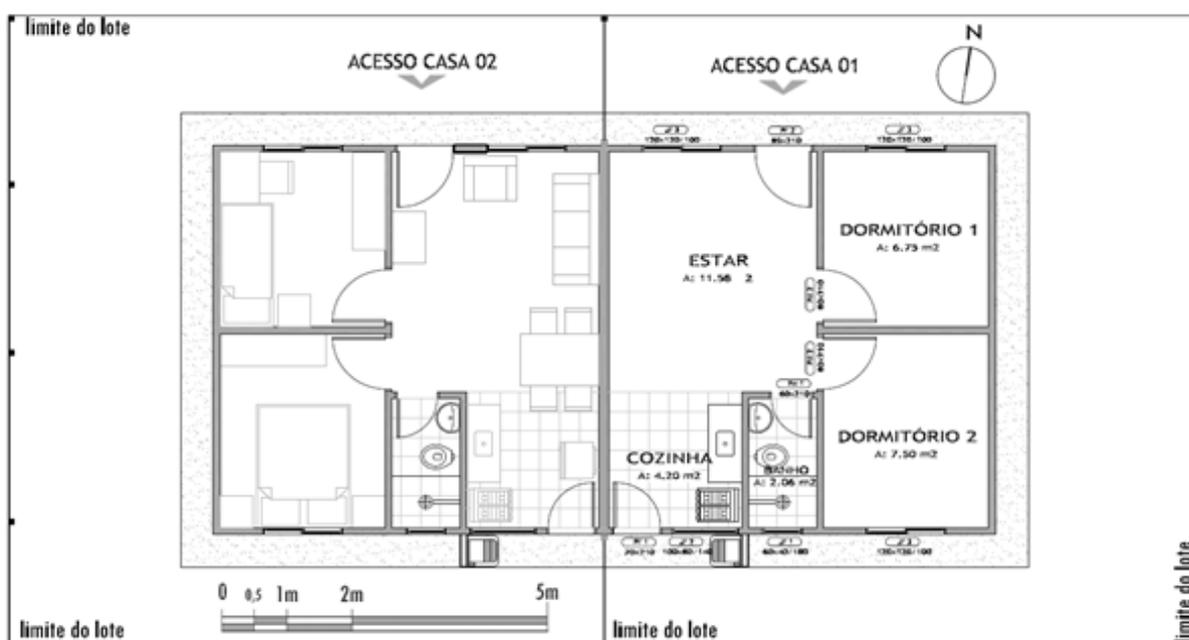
Planta baixa padrão da edificação geminada térrea.
